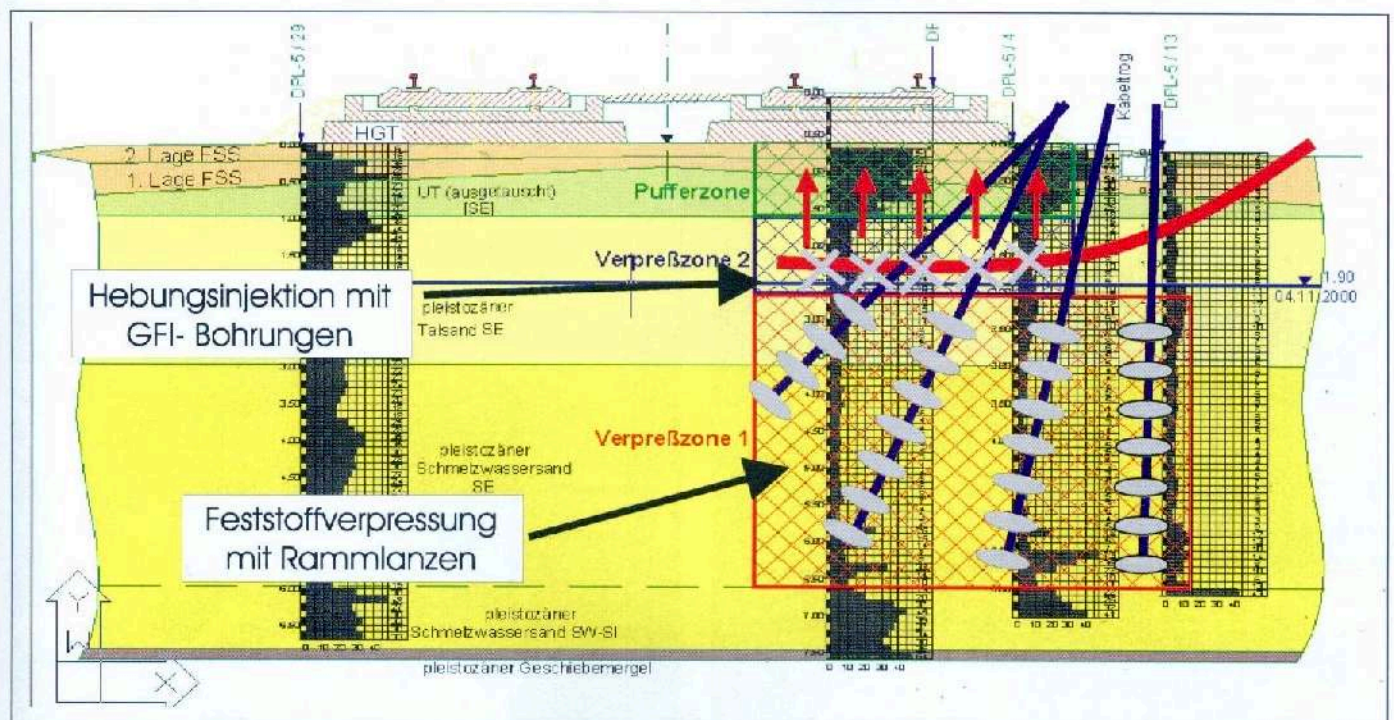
Baugrundaufbau und Anordnung der Injektionsbohrungen
